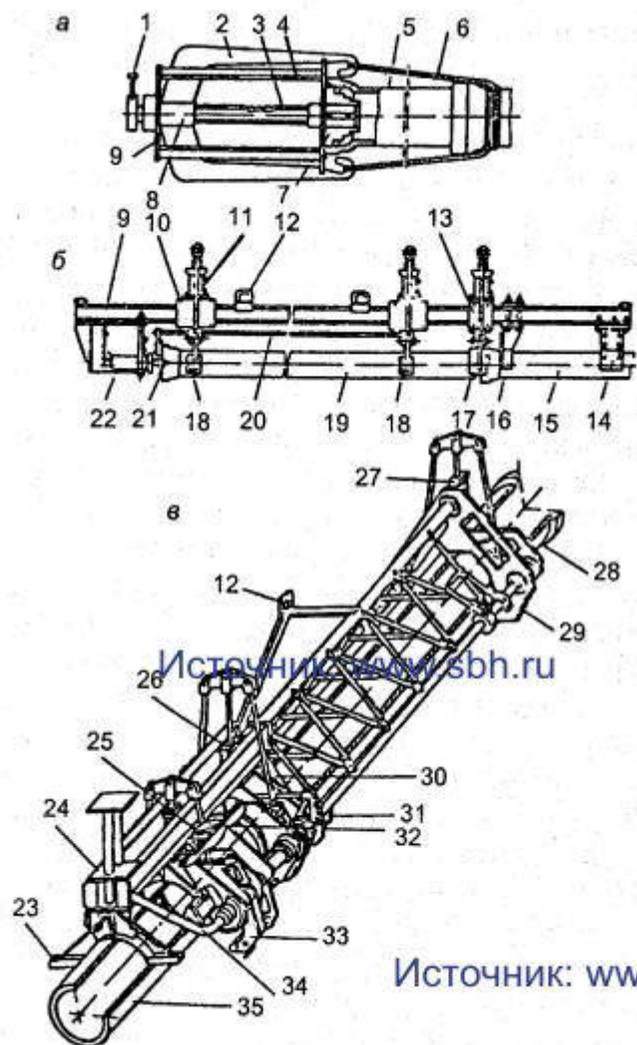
Схемы устройств и навесного оборудования для монтажа чугунных труб:
